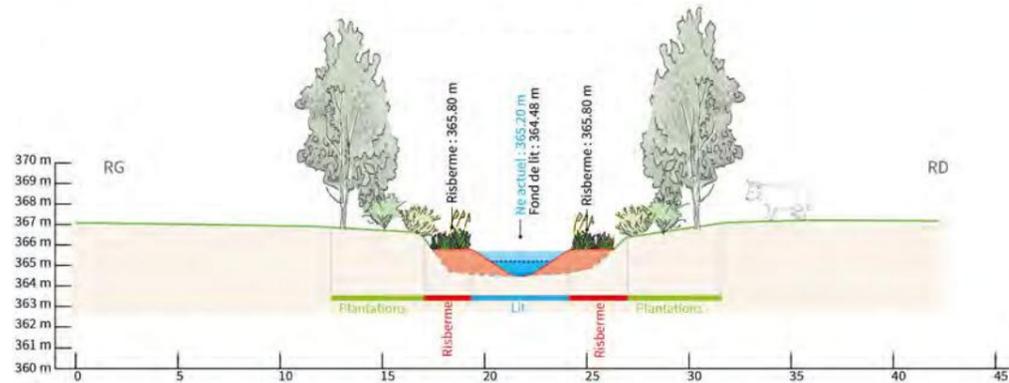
coupe de principe de la restauration du Suran à Gigny (coupe 1)
